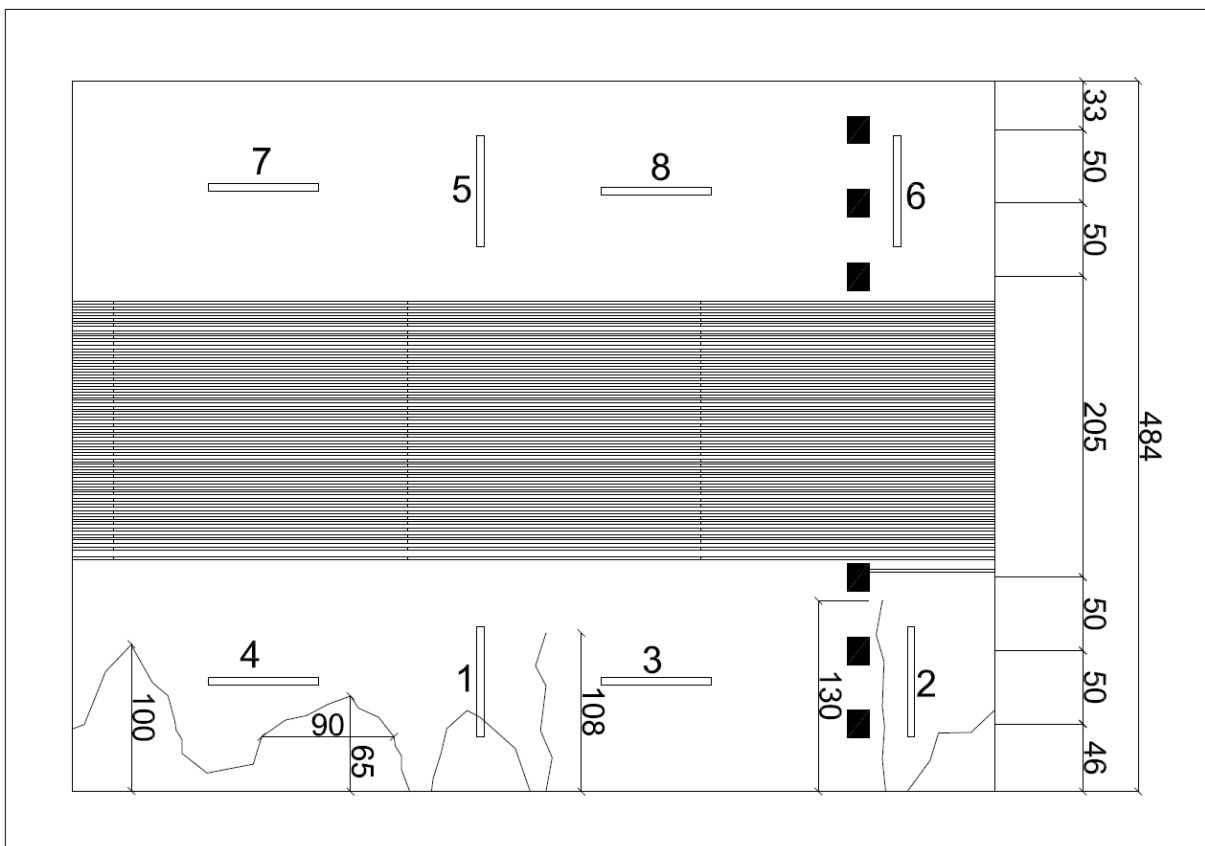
Position des fissures dans le béton sur la surface extérieure du cylindre R2. Les positions des jauges sont également indiquées.
